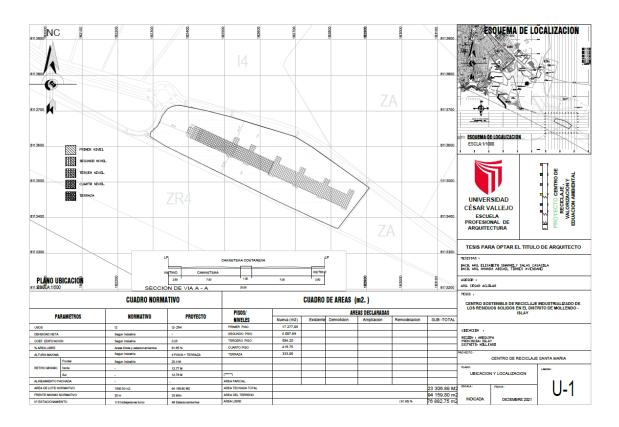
Plano de Ubicación de Proyecto. FUENTE: Elaboración Propia
